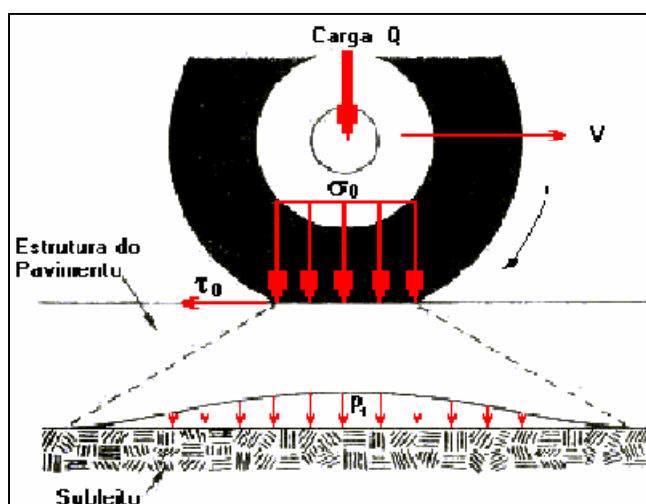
Cargas aplicadas no pavimento e as tensões decorrentes a elas.
